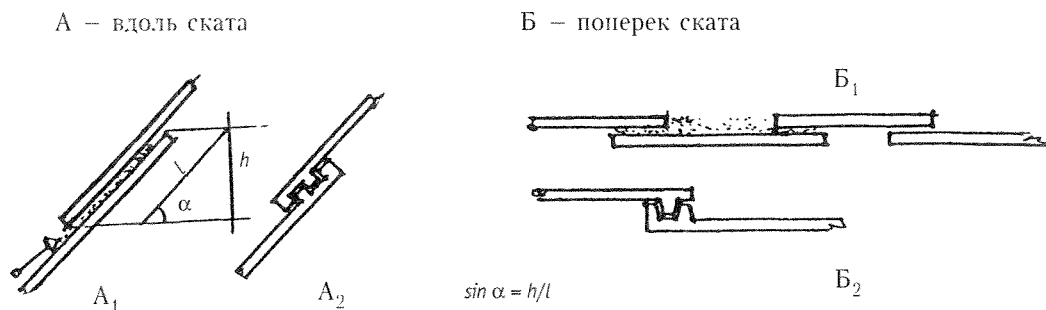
Варианты возможных сопряжений элементов кровли (схемы):
